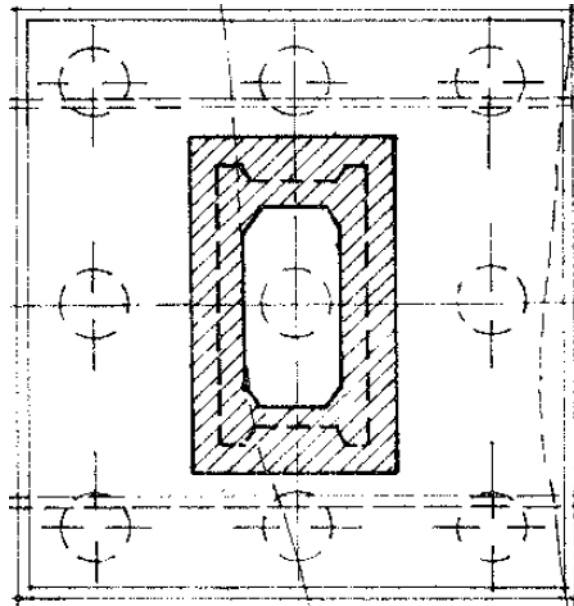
Pianta Pile a 9 pali (P23 e P24)
